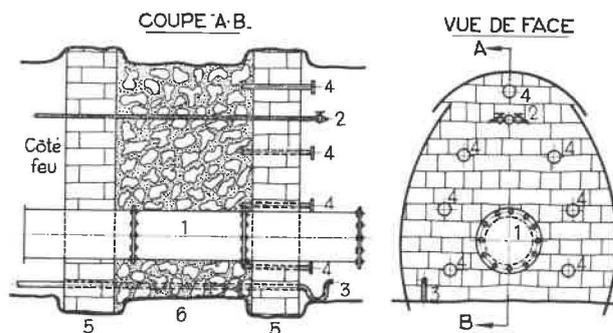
Barrage d'étanchéité. — Cas des chantiers non grisouteux. Entrée ou retour d'air.
